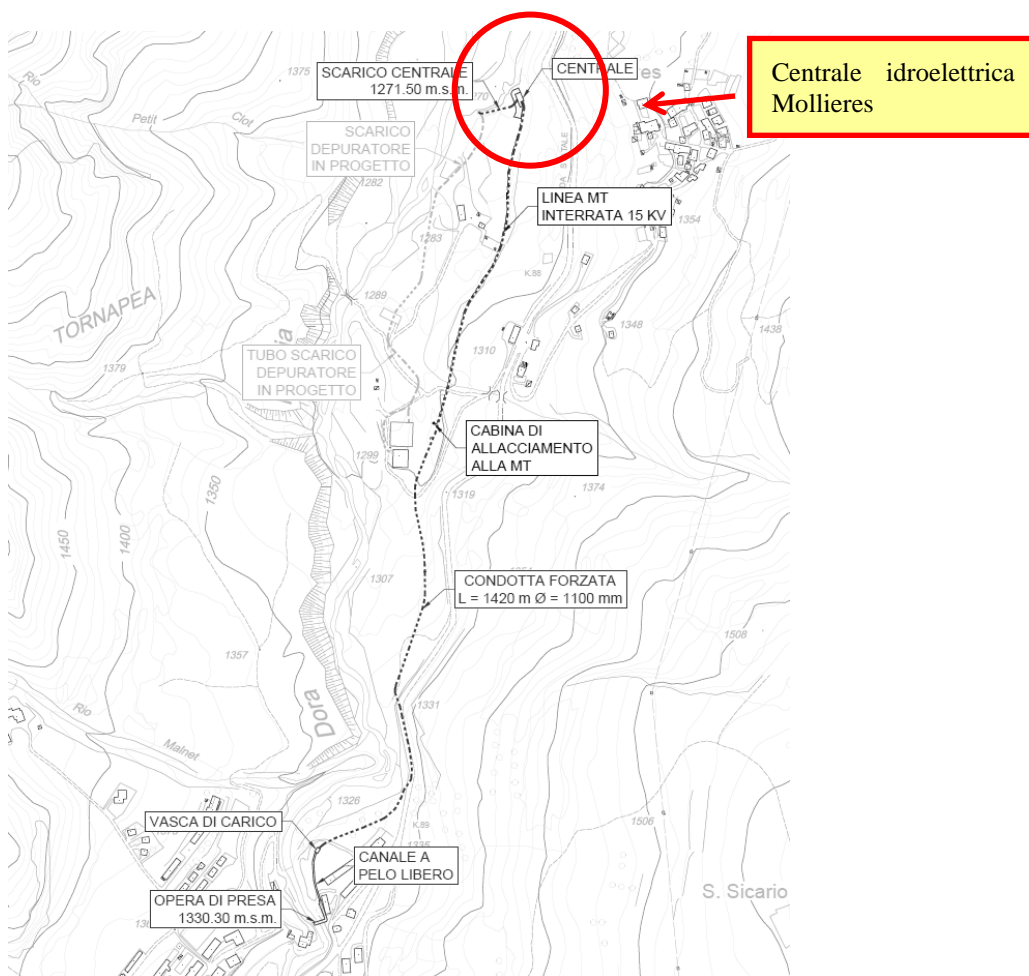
Stralcio planimetria di progetto centrale idroelettrica Mollieres
